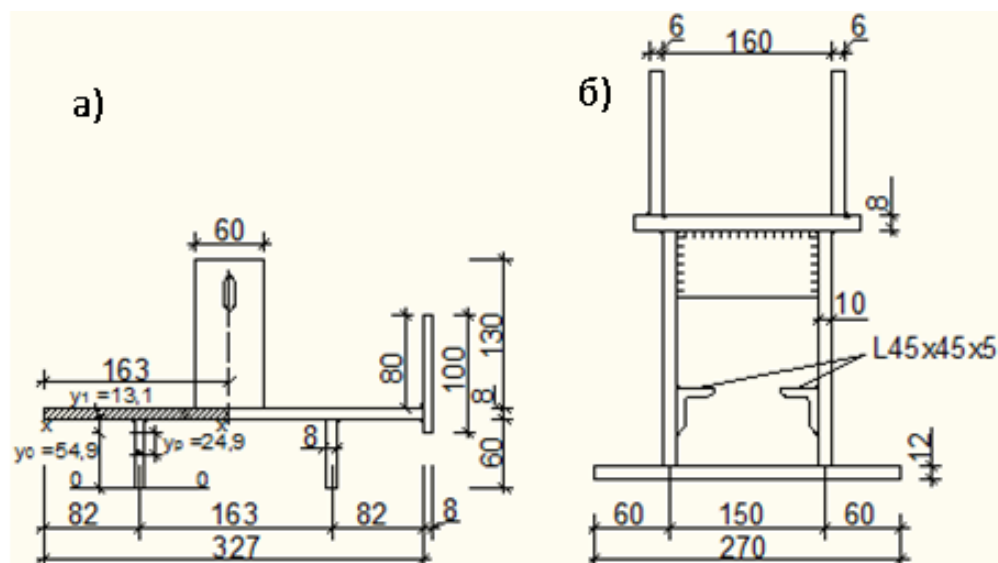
К расчету опорного узла распорной системы треугольного очертания: а – к расчету упорной пластины; б – к расчету опорной пластины
